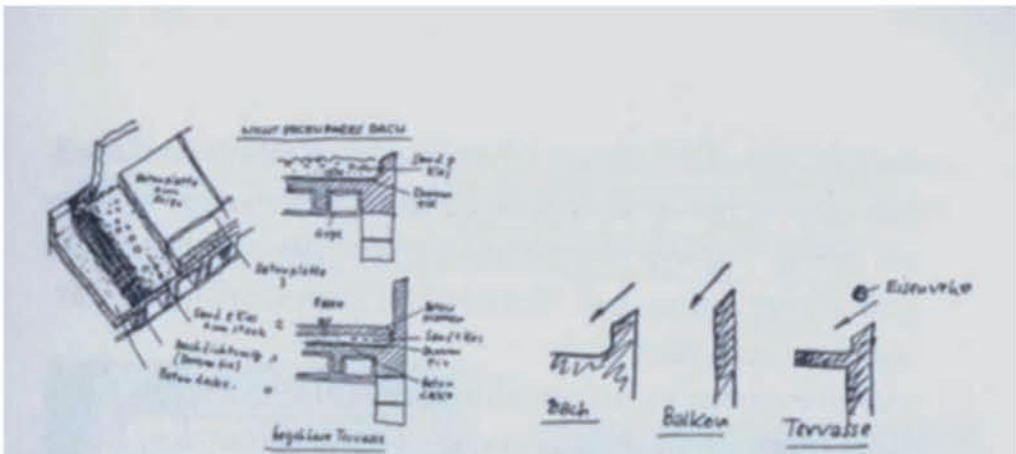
Cubierta en sistema de hormigón aligerada con piedra pómez.
